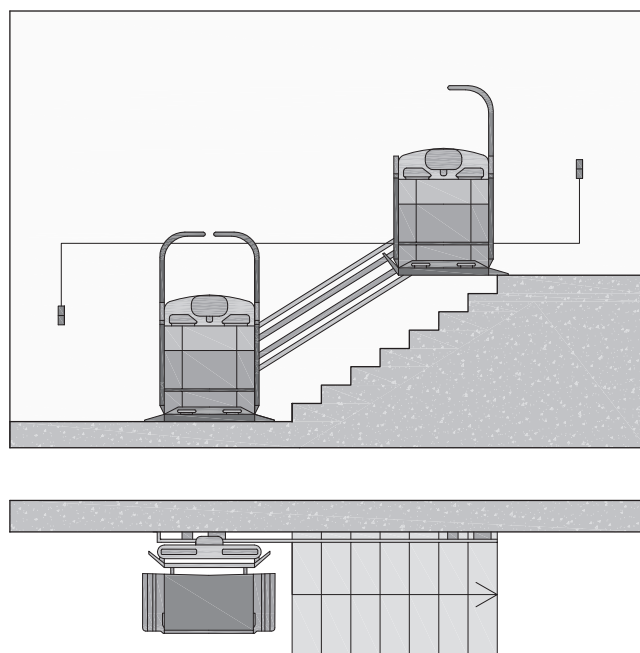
Vista en planta de una plataforma salvaescaleras.
